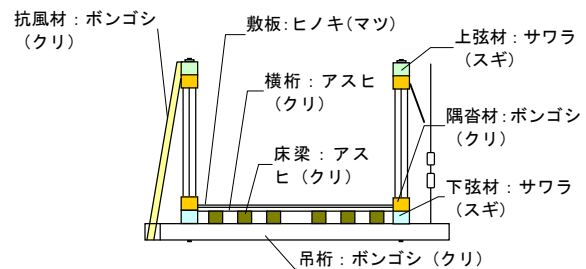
補剛桁断面図 (カッコ内は原設計時の使用材)
